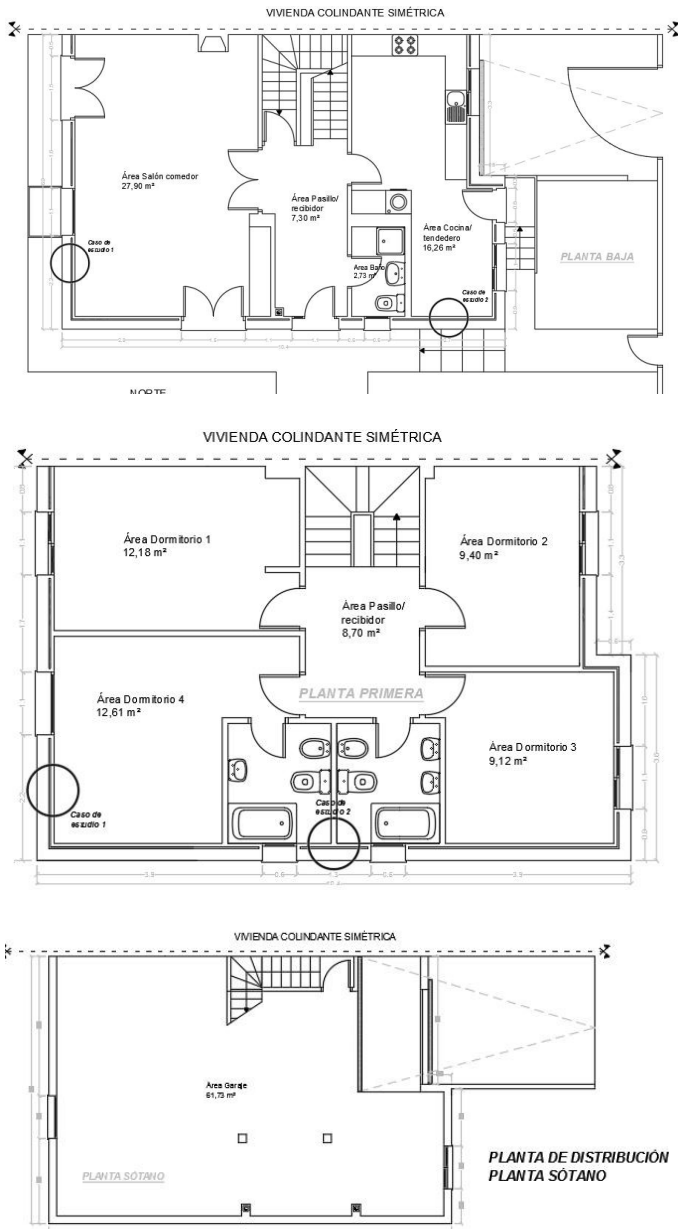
Planos de edificio modelo. Elaboración propia . a. Planta baja. b. Planta primera. c. Planta sótano
